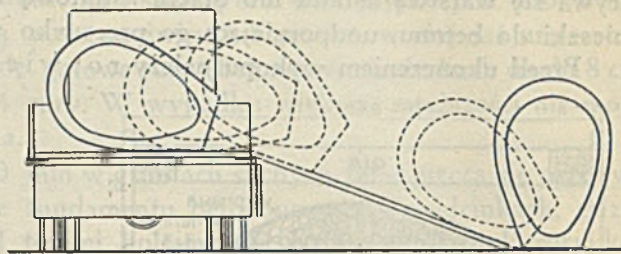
Kanał na palach drewnianych zabetonowanych w płycie.
